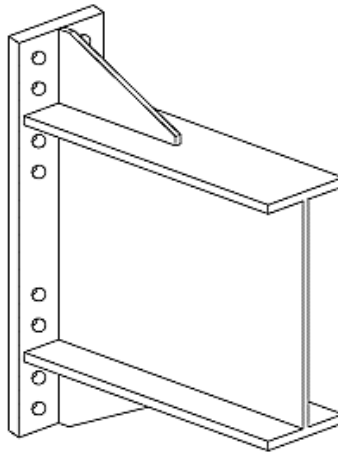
Conexión de placa fuerte (8ES – 1-1/4-1-3/4-30) (Sumner E. 2003).
